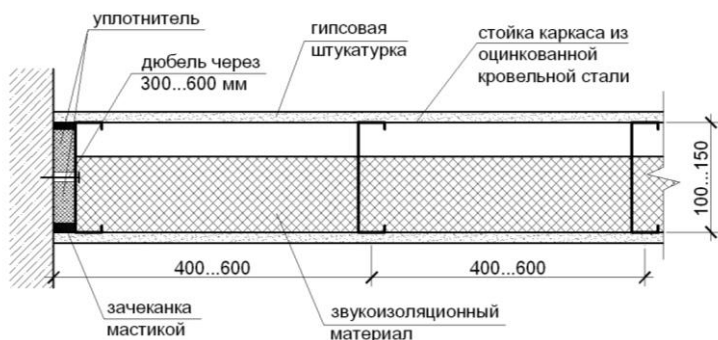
Горизонтальное сечение по каркасной перегородке
